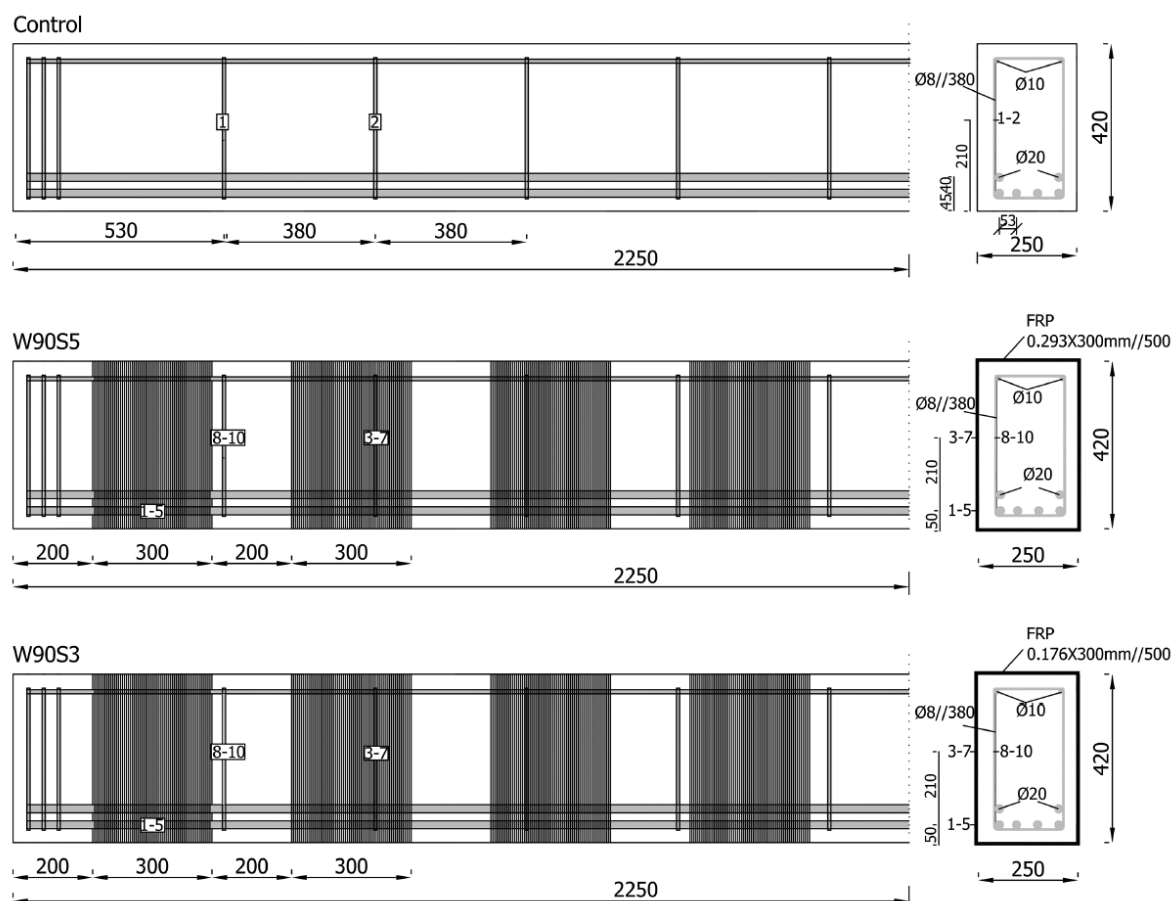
Medidas y configuración de los refuerzos de la viga control, la viga W90S3 y la viga W90S5
